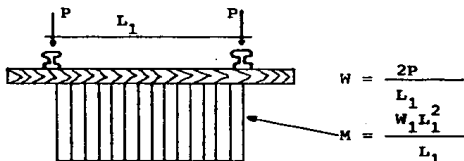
b Distribución de esfuerzos cuando el durmiente sólo se apoya en el centro.
